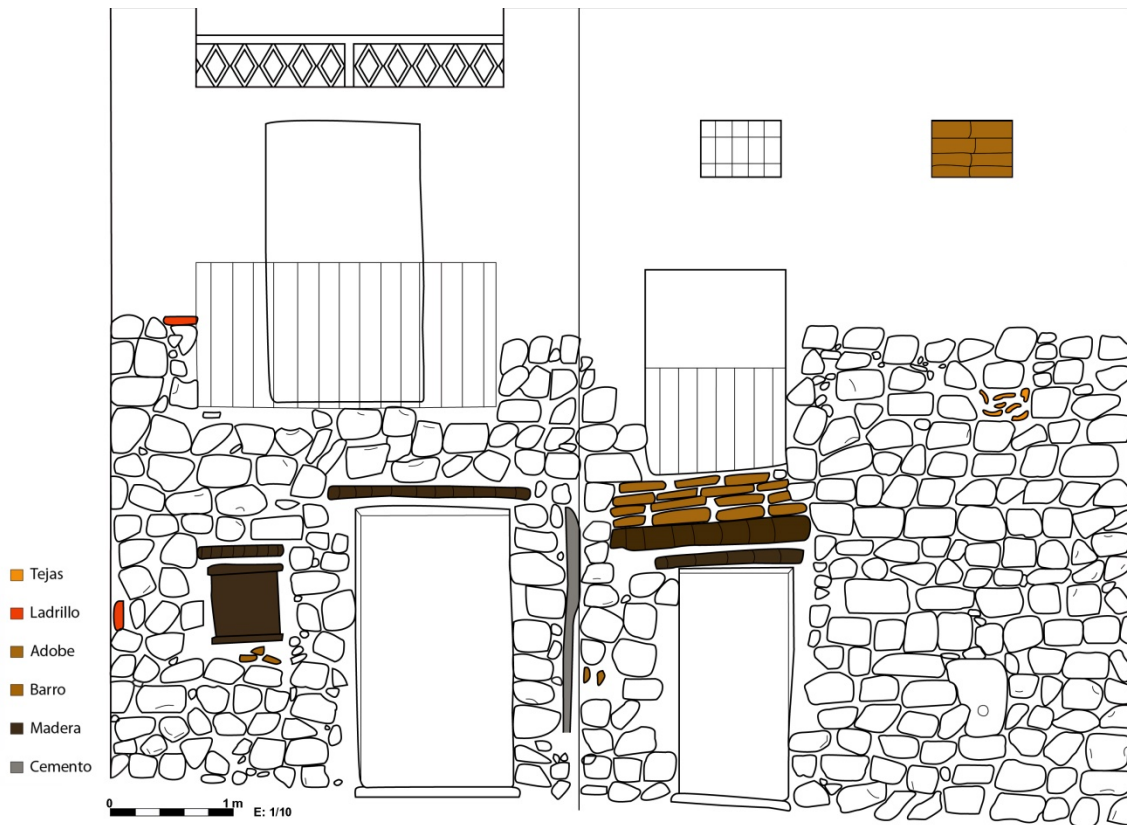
Planimetría de la fachada de las viviendas 45-47
